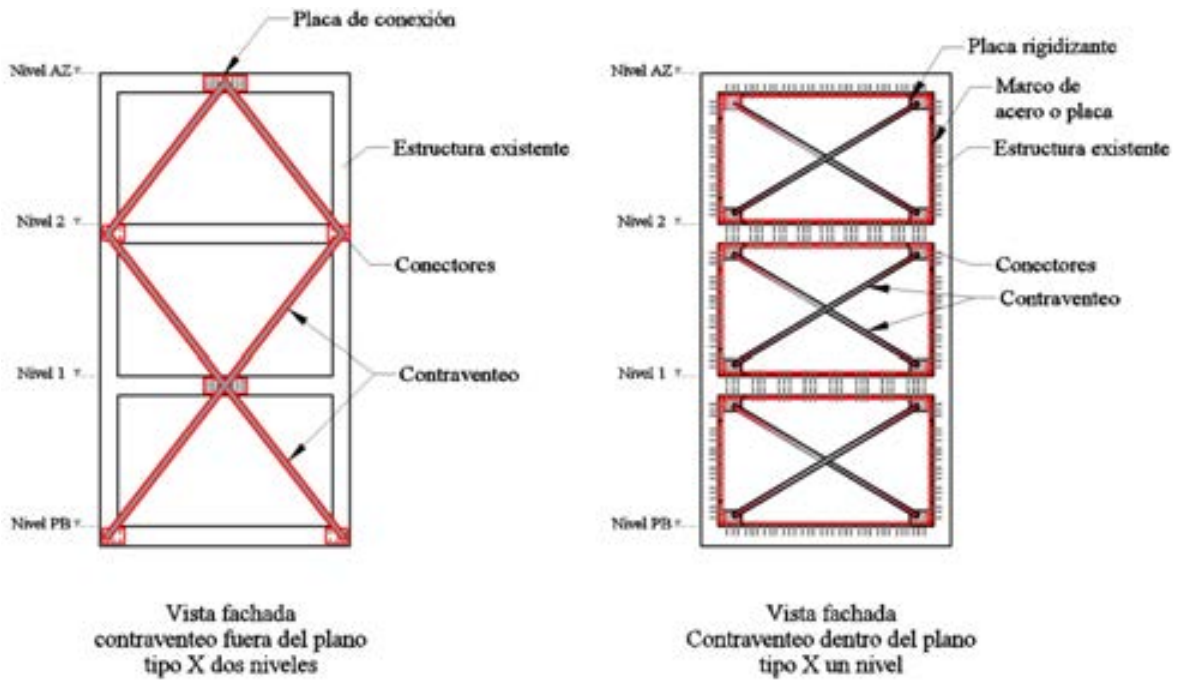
Vista frontal de contraventeos colocados dentro del plano del marco original y externos a él
